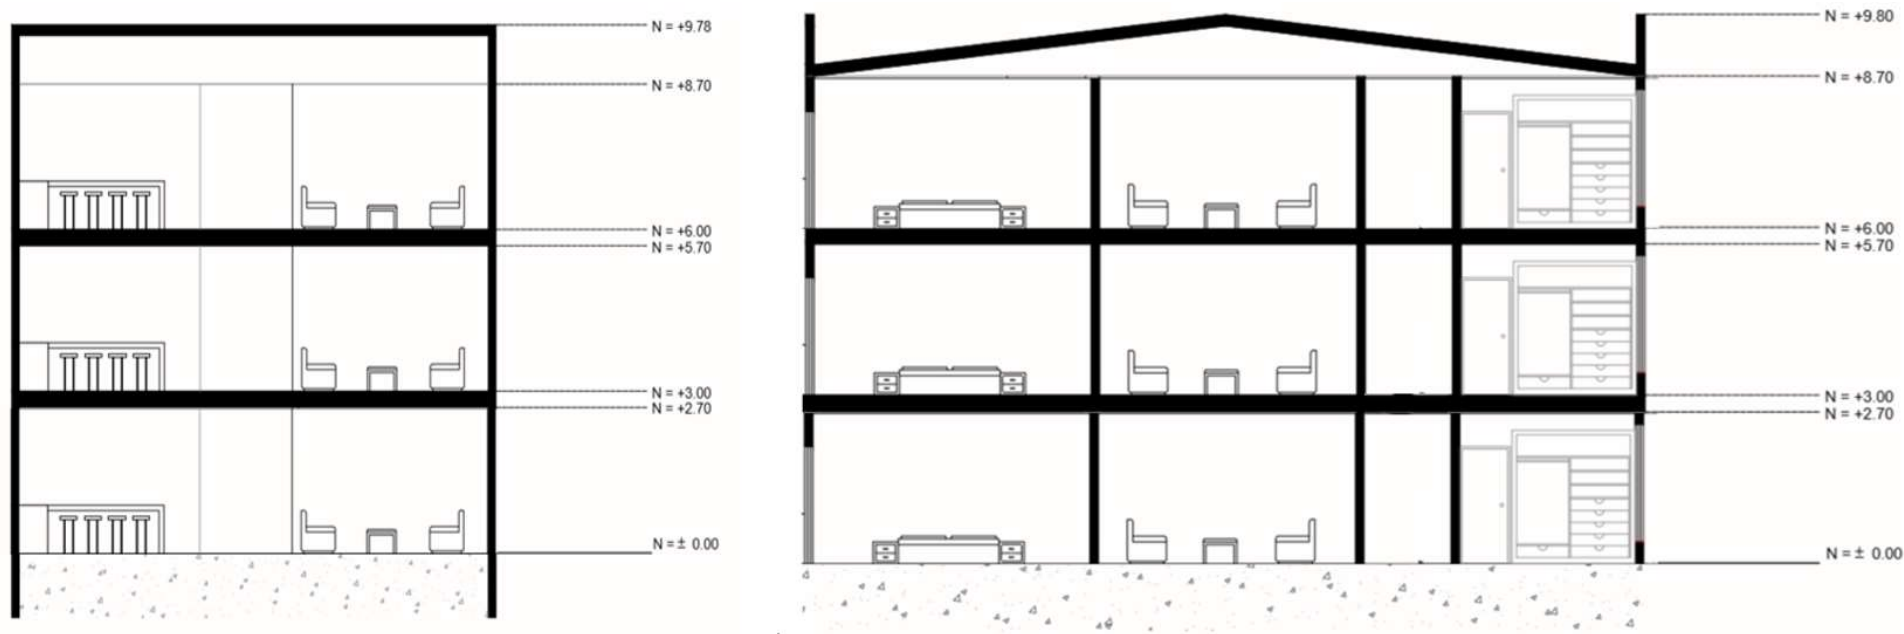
Corte Longitudinal y Transversal de la edificación multifamiliar.
